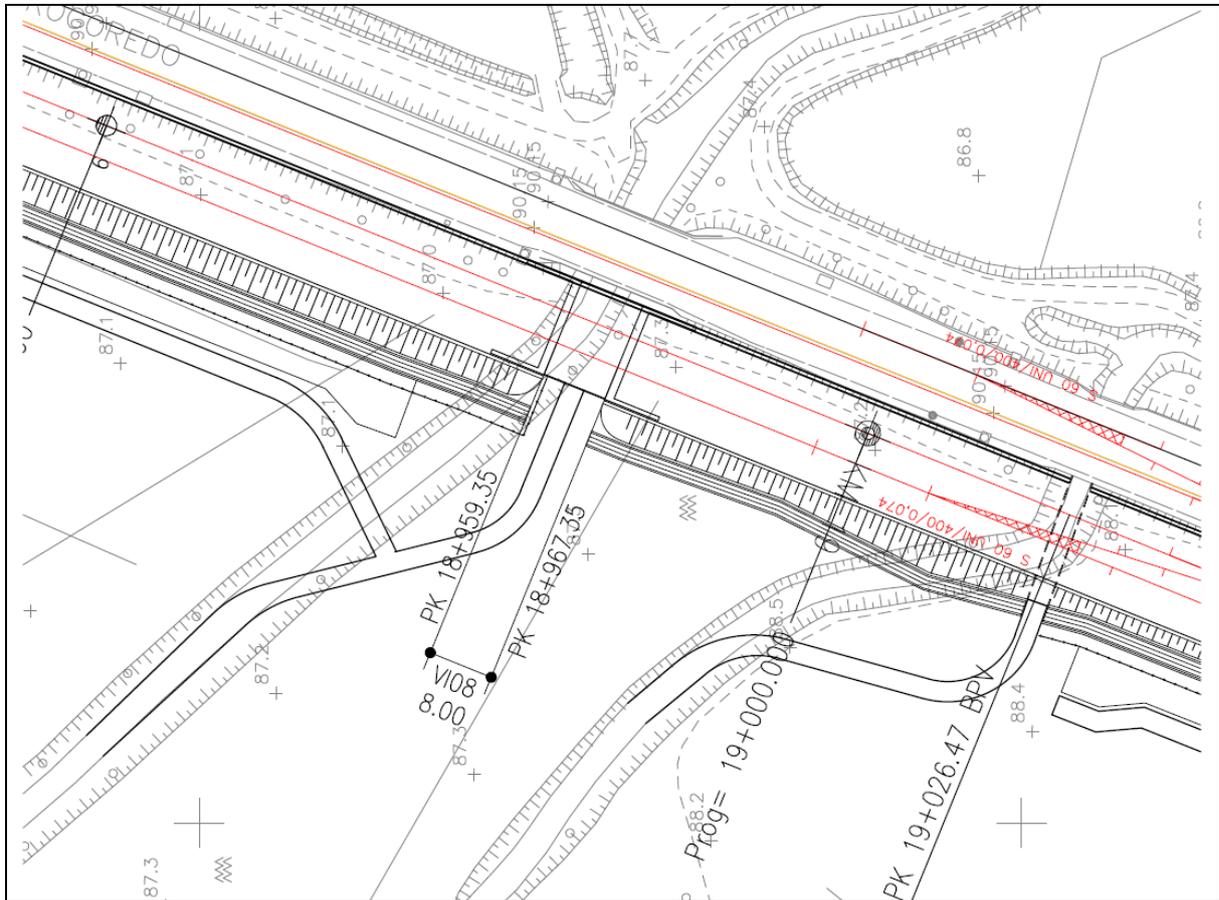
Planimetria di progetto con VI08 per scavalco della Roggia Barona.
